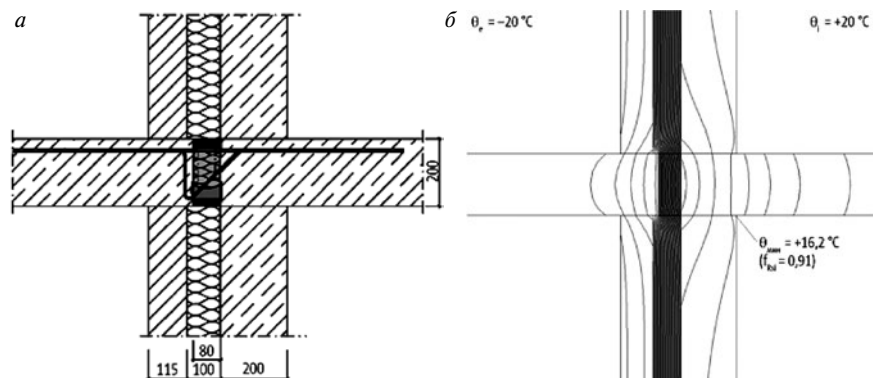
Стык балконной плиты с наружной стеной с использованием теплоизоляционного элемента Schöck Isokorb® тип K30-CV30 для системы с теплоизоляцией: а – конструктивное решение стыка; б – характер распределения температур в зоне стыка
